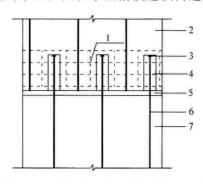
上下预制剪力墙构造钢筋约束预留圆孔浆锚搭接连接构造 1-钢筋笼; 2-上层墙体; 3-钢筋墩头; 4-预留孔灌浆; 5-坐浆层; 6-竖向钢筋; 7-下层墙体
